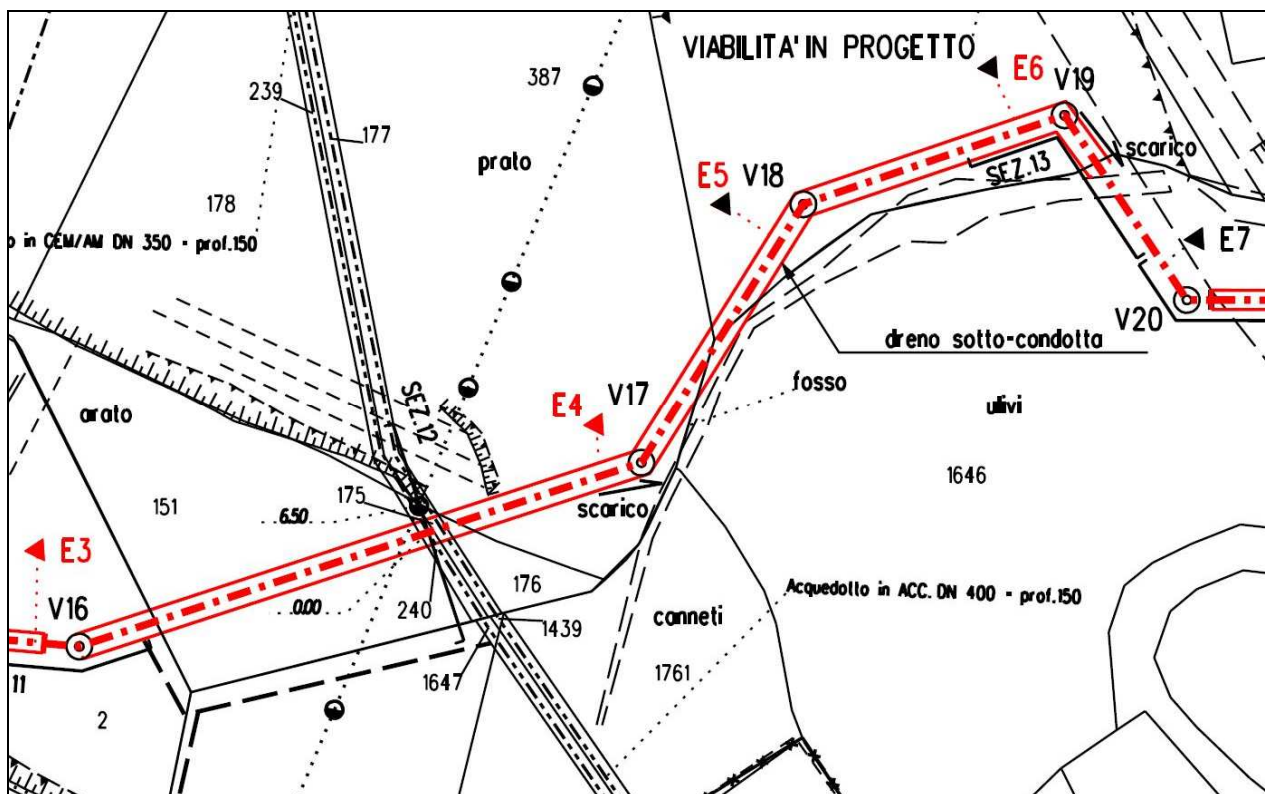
Tratto di esecuzione di trincee drenanti sotto condotta profonde 3-4 m
